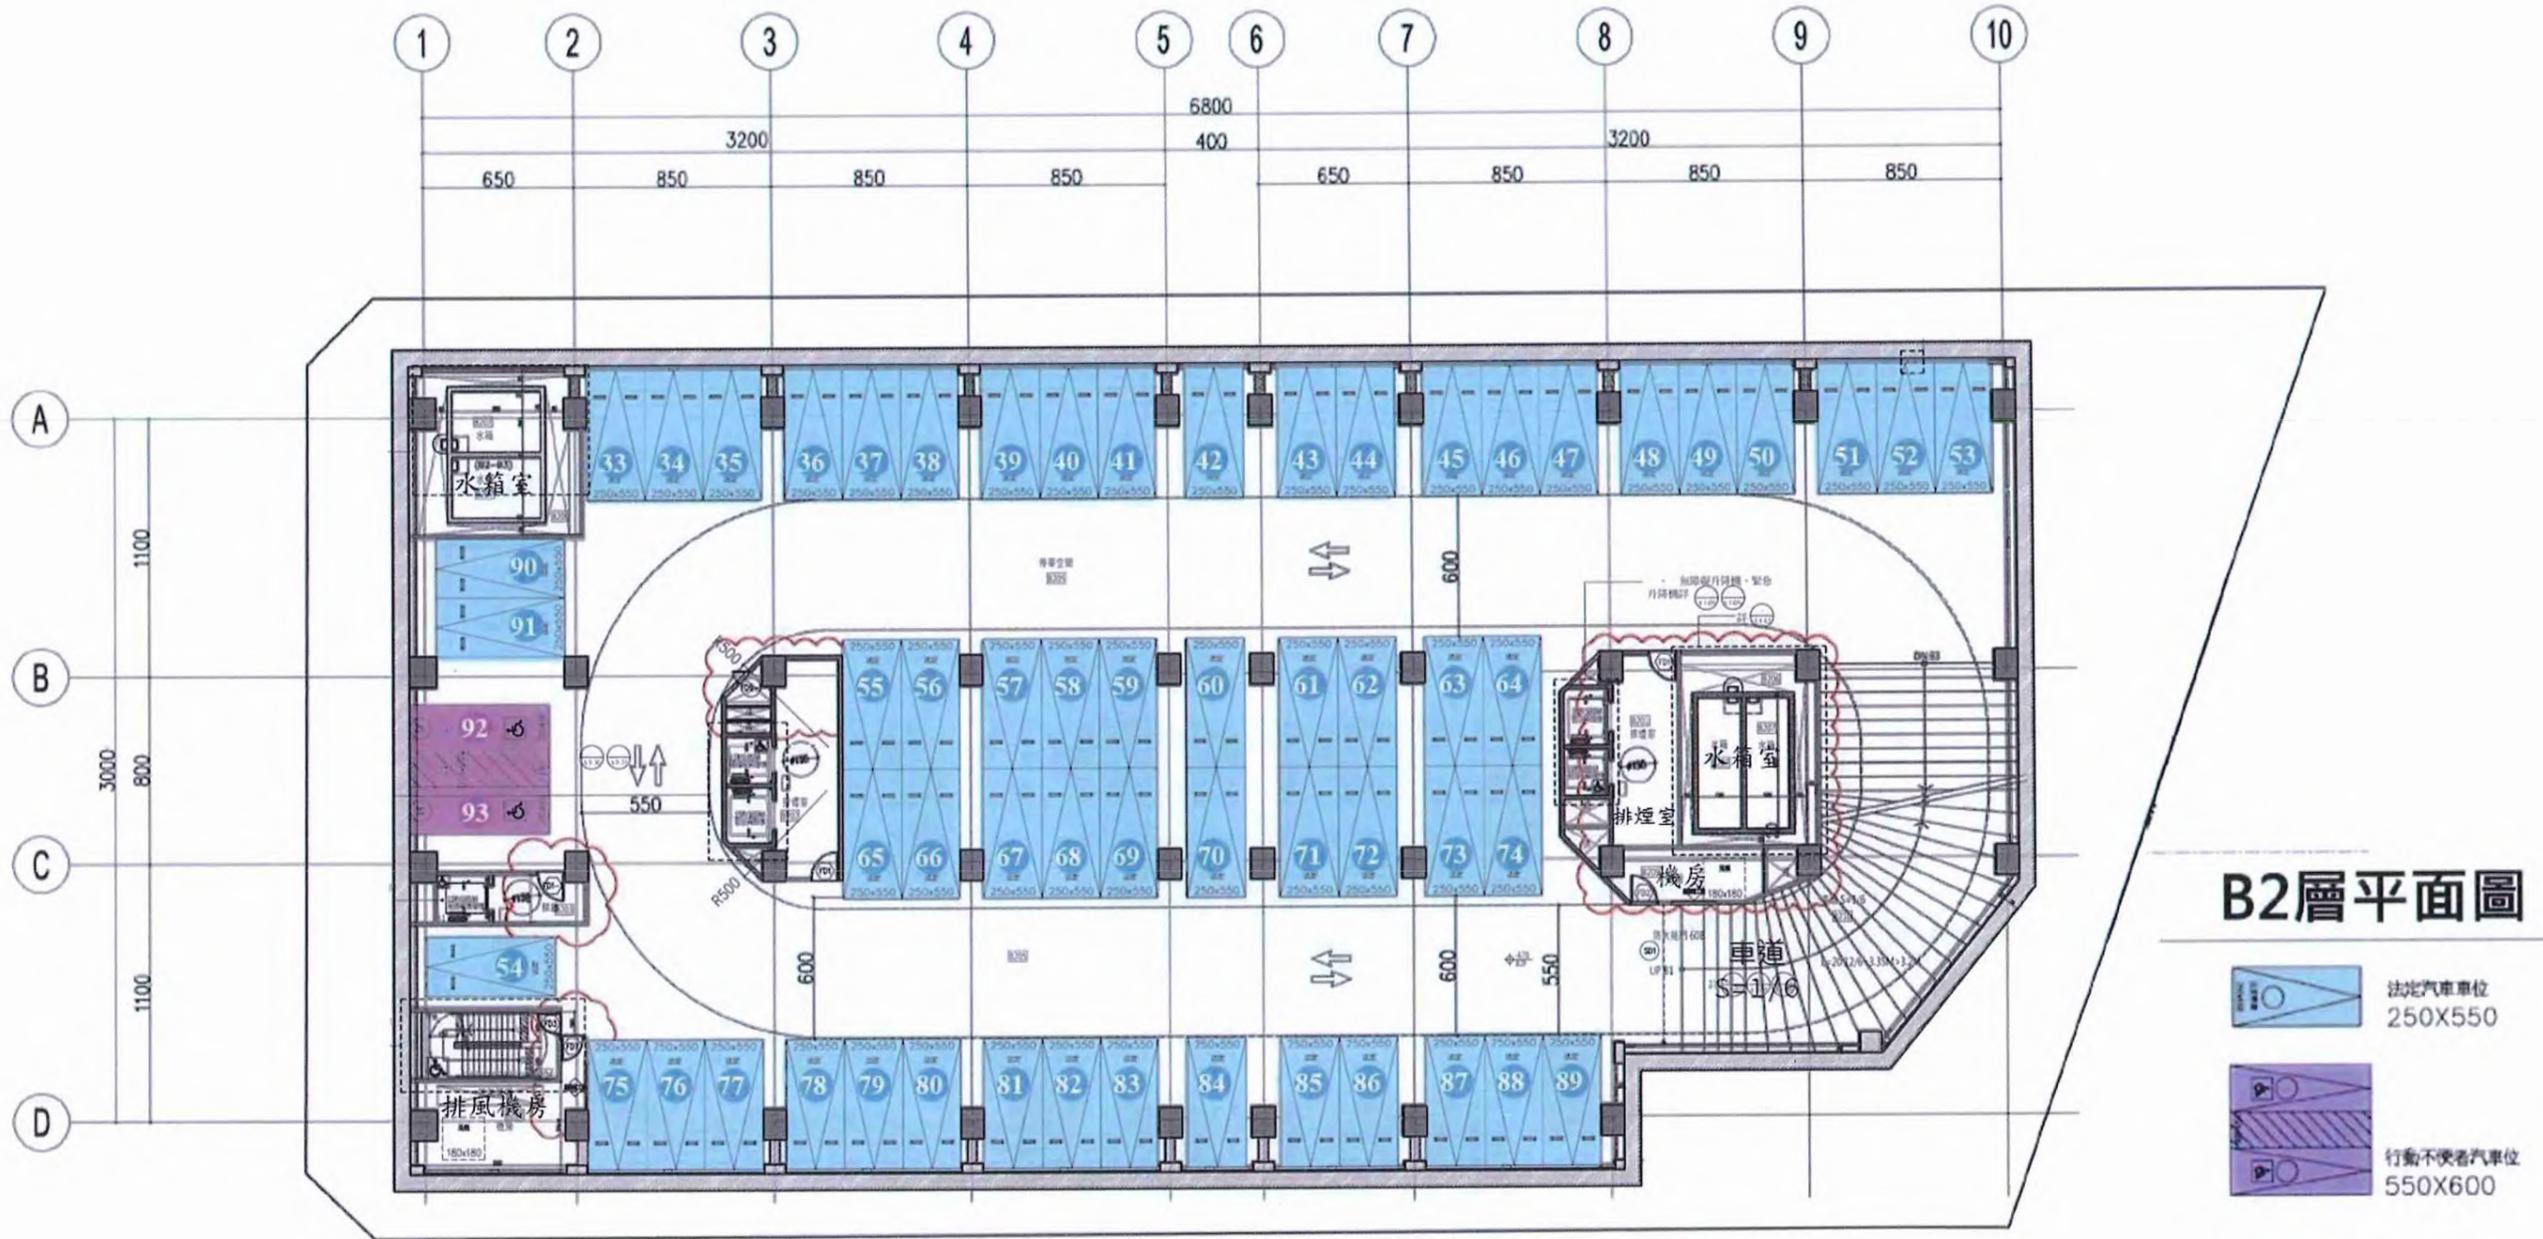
地下二層平面暨面積計算圖(S:1/300)
